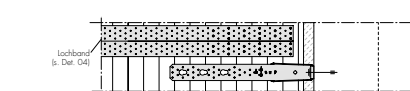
Zuganker Typ 2 Dachdeckenscheibe an Stahlbeton
